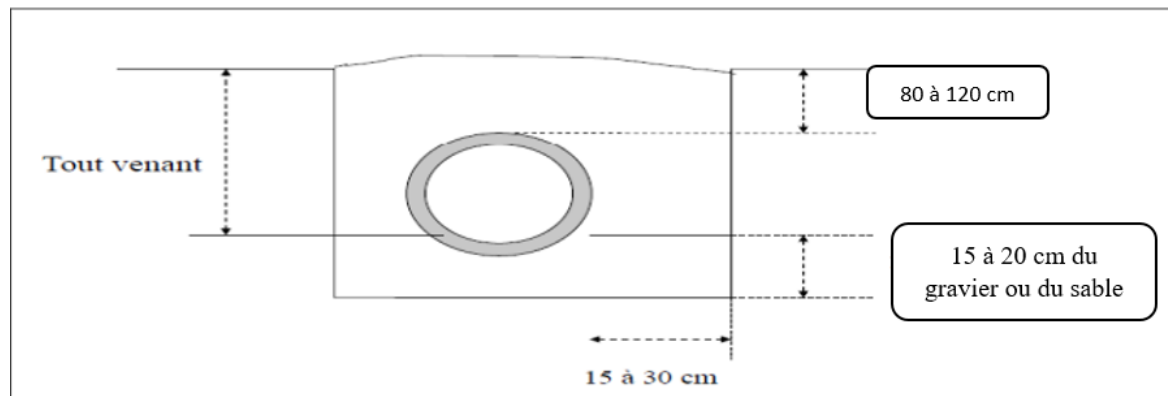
Pose de conduite en tranchée dans un terrain ordinaire
